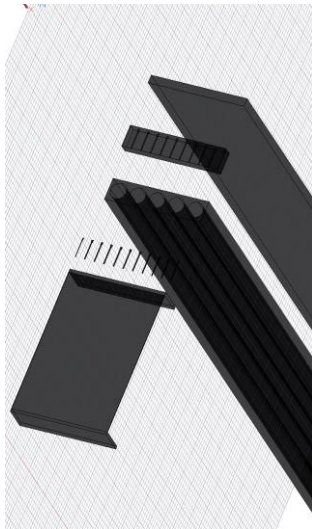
Элементы модели сталежелезобетонного перекрытия по сборной железобетонной плите с гибкими упорами. / Elements of the model of composite reinforced concrete slab along reinforced slab with flexible stops.
